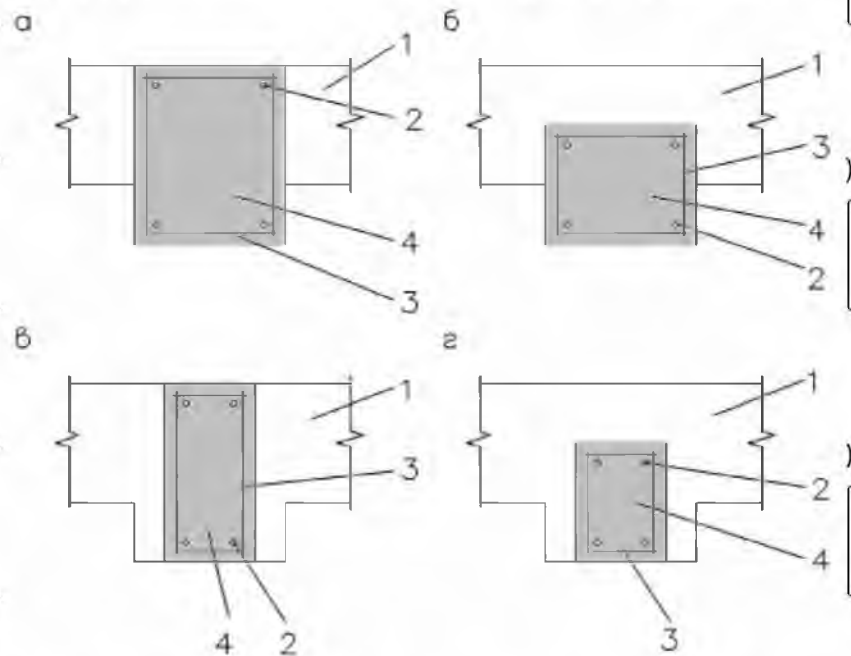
Посилення простінків із пілястрами монолітними залізобетонними елементами: а, в – кладка, яка посилюється; б, з – влаштування поглиблень із однієї сторони; 1 – посилена кладка; 2 – поздовжня арматура; 3 – поперечна арматура; 4 – бетон посилення
